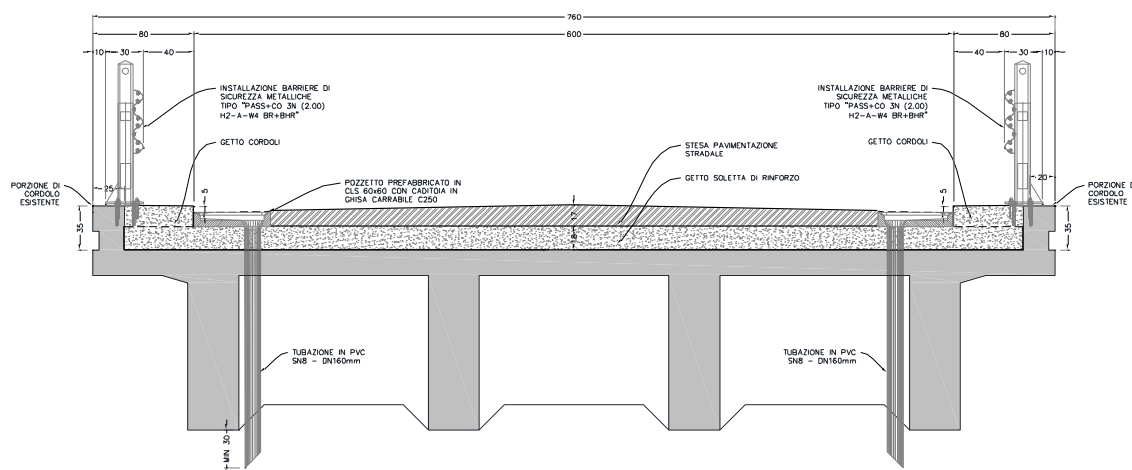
Sezione trasversale allo stato di progetto - su impalcato
